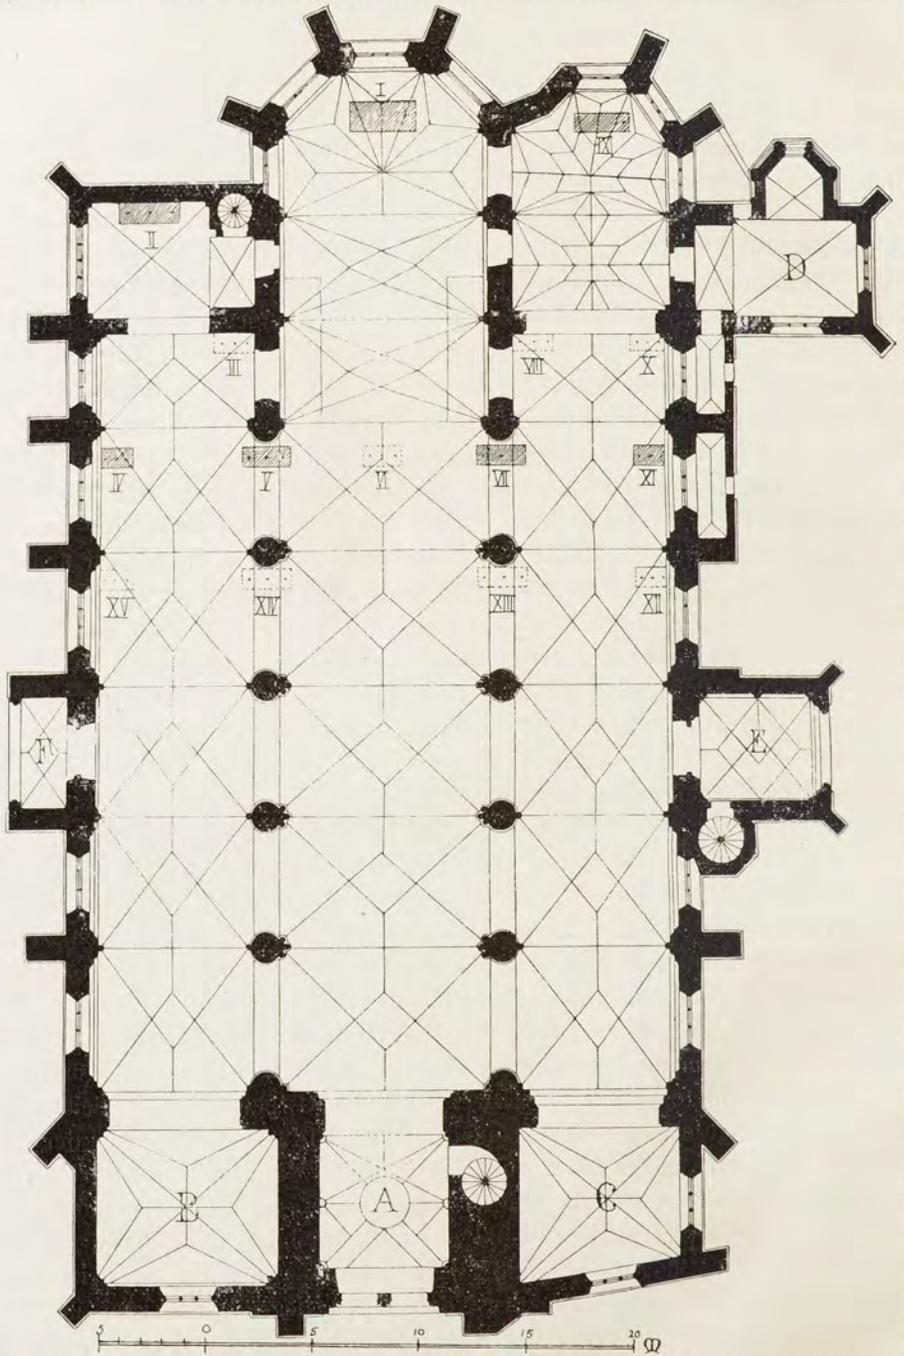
Kalkar. Grundriss der St. Nikolaus-Pfarrkirche.
